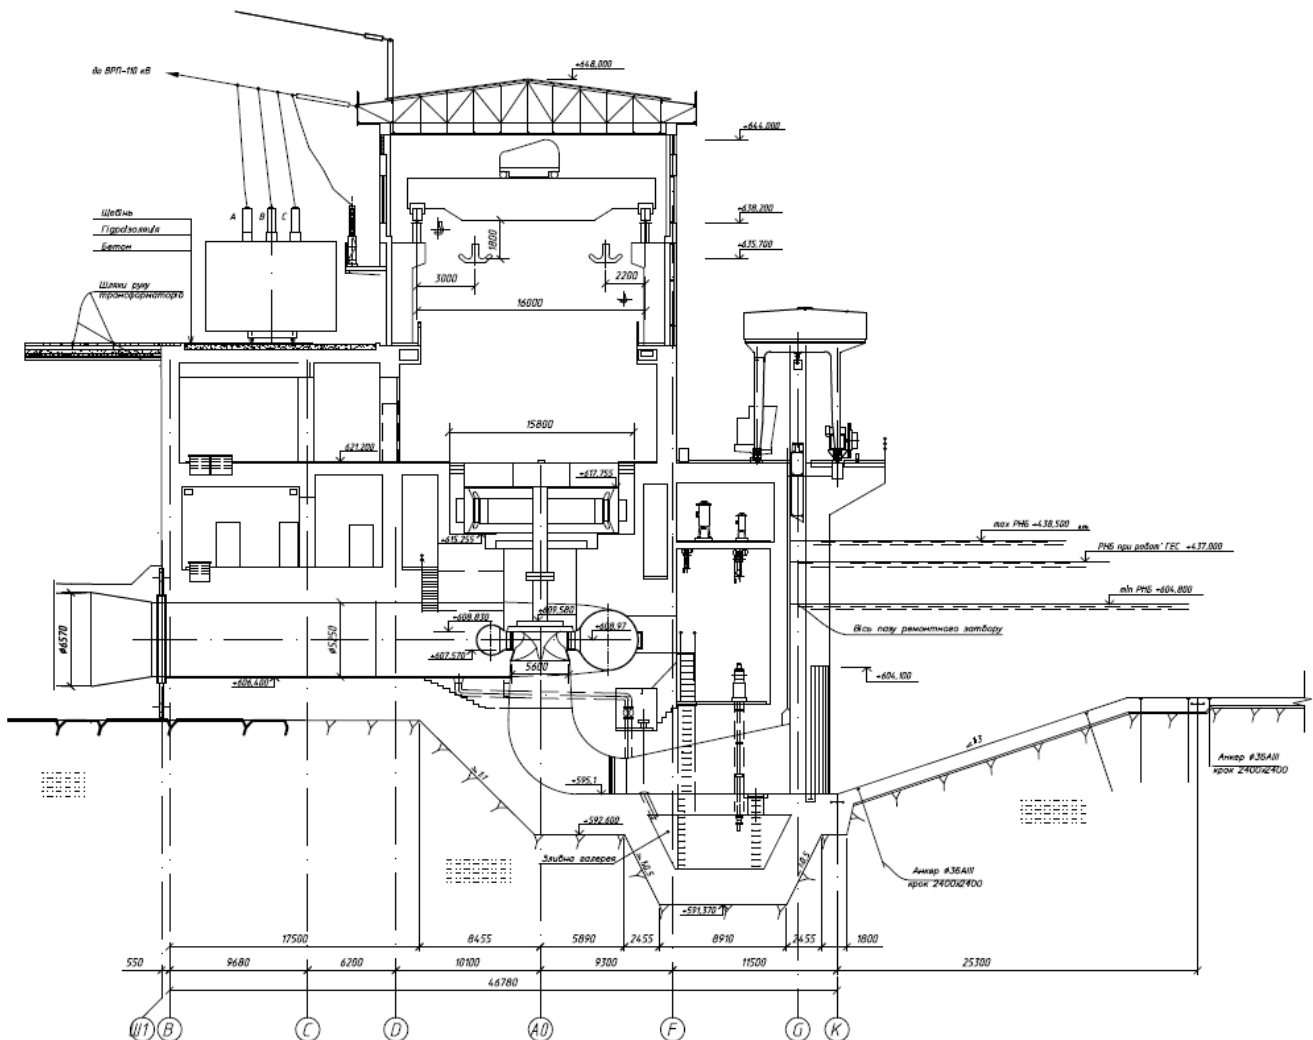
Поперечний переріз будівлі ГЕС пригребельного типу на скельній основі з РО турбінами
